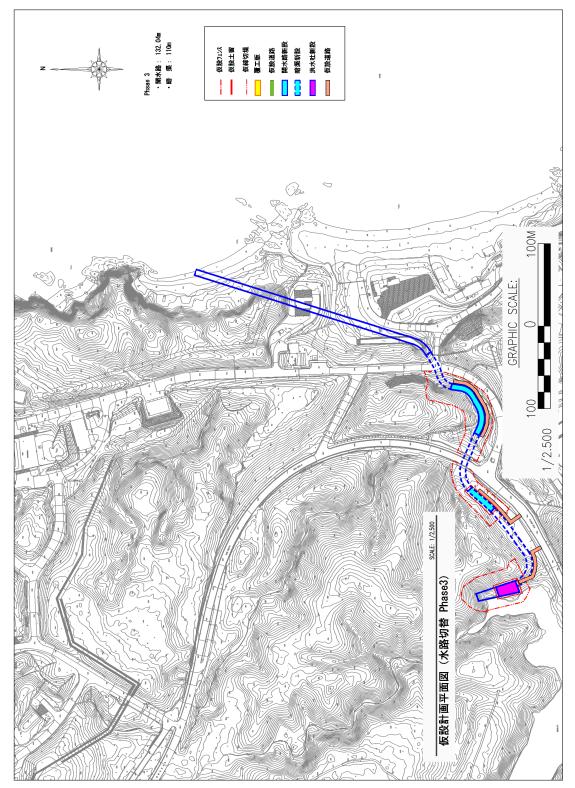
(3) 美謝川の切替え仮設計画平面図 (Phase3)
